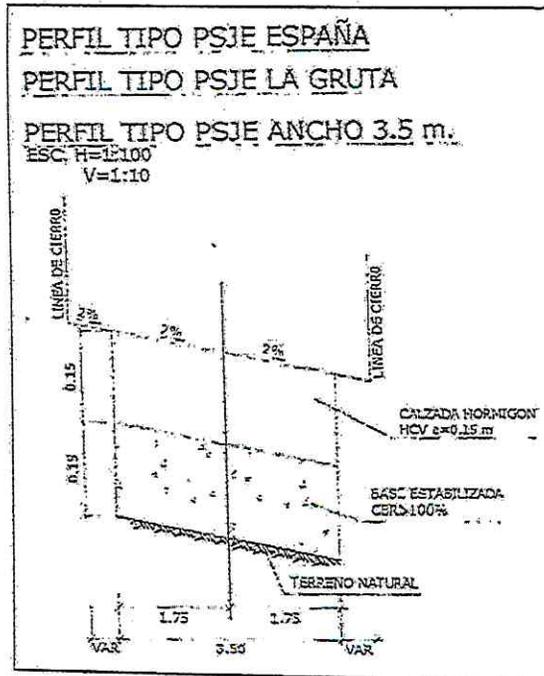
Perfiles Tipos Pasajes Proyecto de Pavimentación Localidad de Lourdes Sector 3 Comuna de Vicuña.
